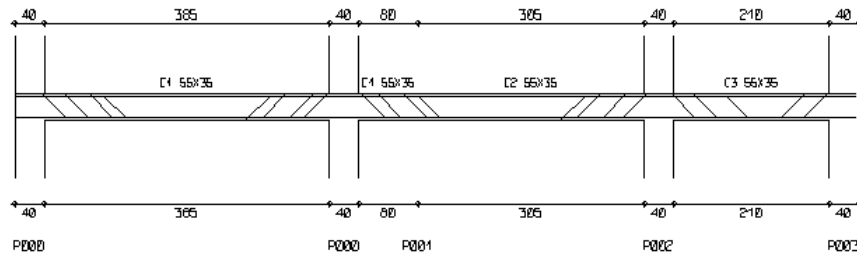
schema armature – schema momenti resistenti [kg·cm]
